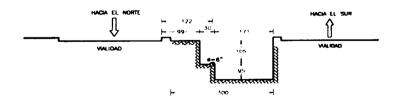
DETALLES DE LAS CALAS No. 1 Y 2
